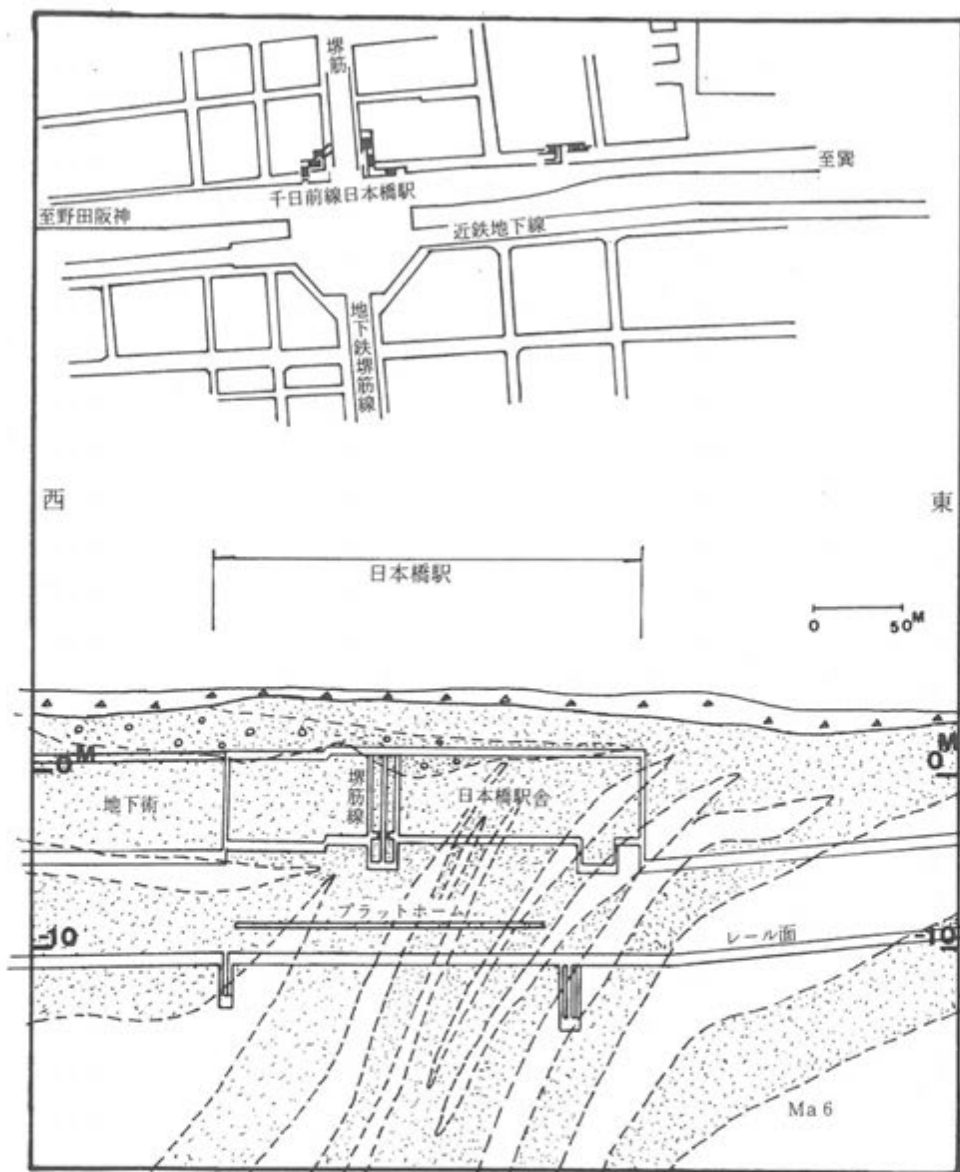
地下鉄日本橋駅付近の平面図と断面図（凡例は図2参照）
